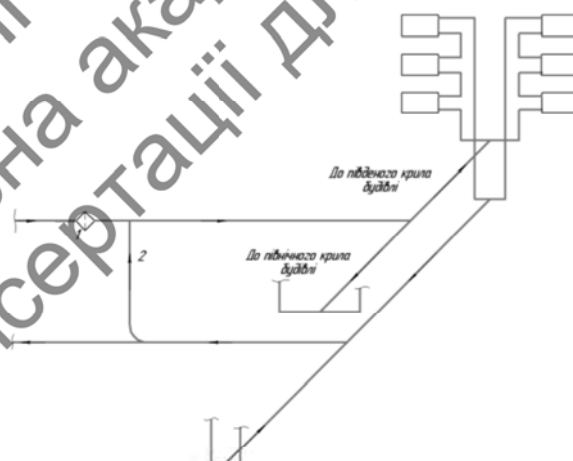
Схема існуючої системи опалення (з елеваторним вузлом) корпусу №1
